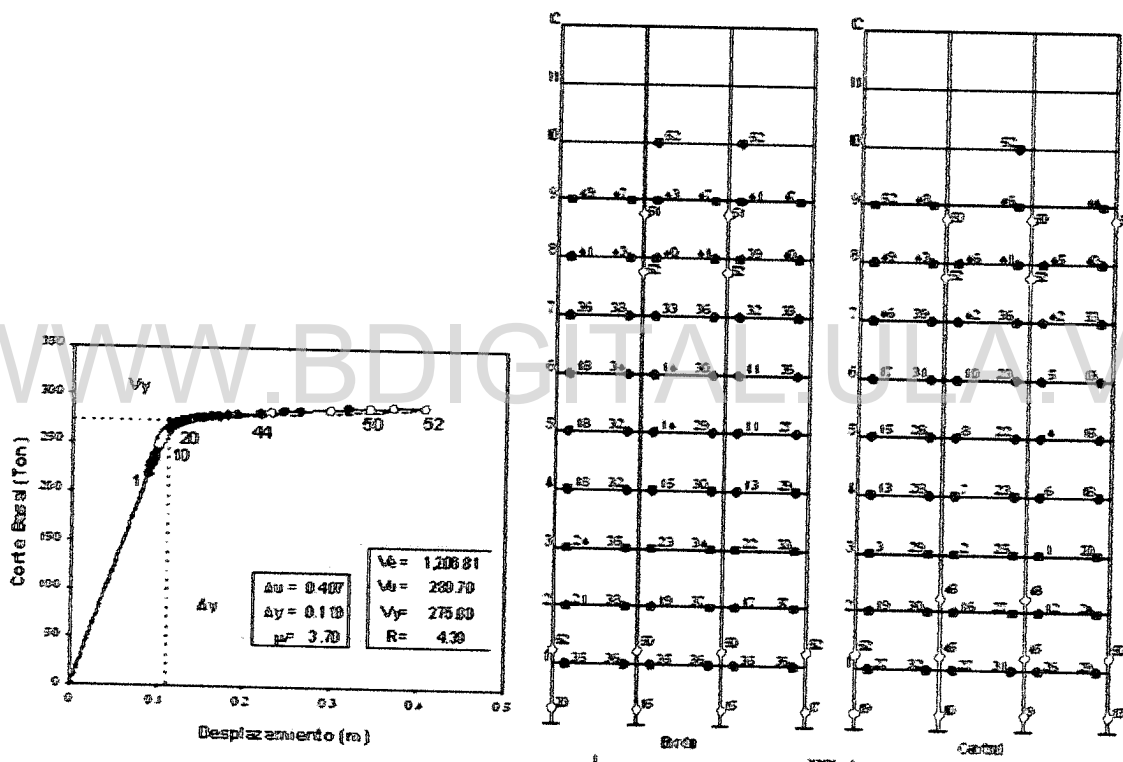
Edificación de 12 pisos con mampostería 12PSM
